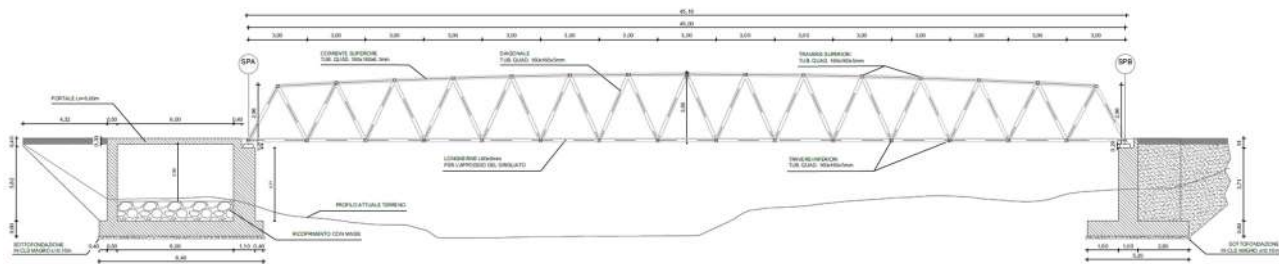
Passerella ciclopedonale – Sezione longitudinale
